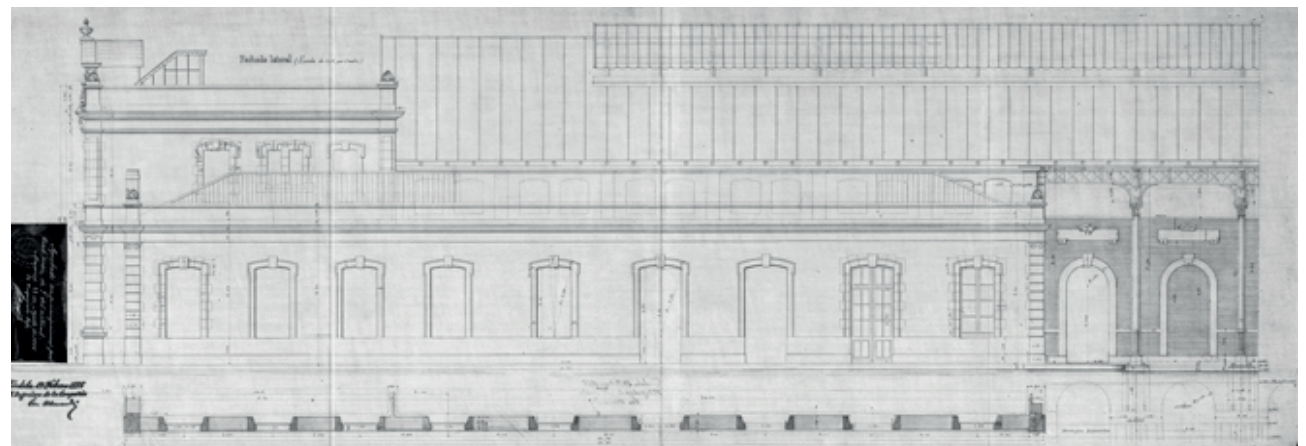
Plano original de la fachada lateral de la estación de Benalúa
